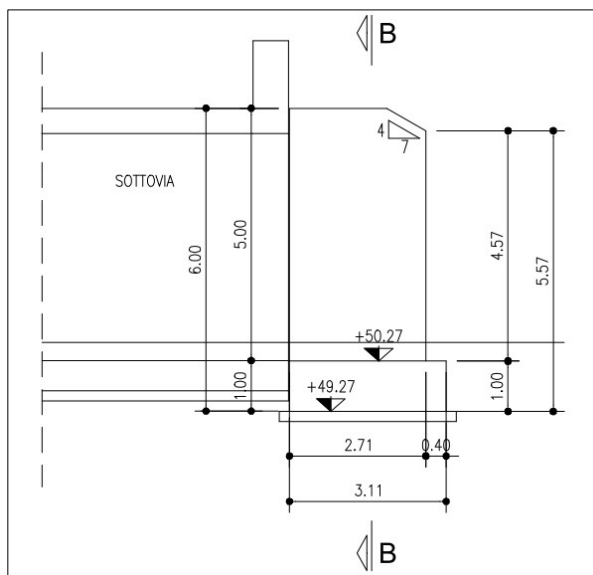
Sezione trasversale del muro d'ala – Lato Nord
